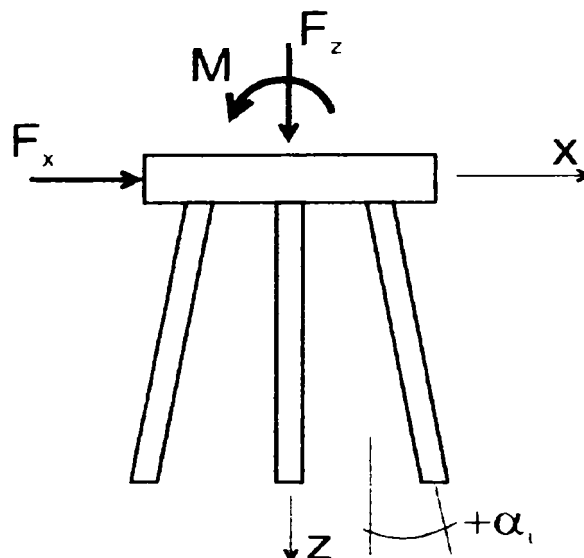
Schema de încărcare a unui grup plan coloane
